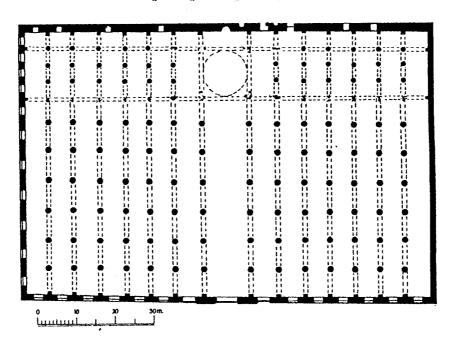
مسقط أفقي لجامع حران . (عن : أحمد فكرى) .
